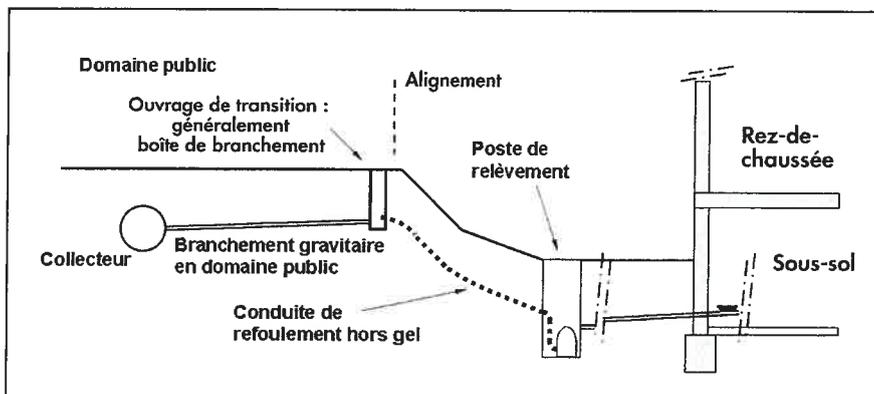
Exemple de branchement par pompage vers un collecteur gravitaire
